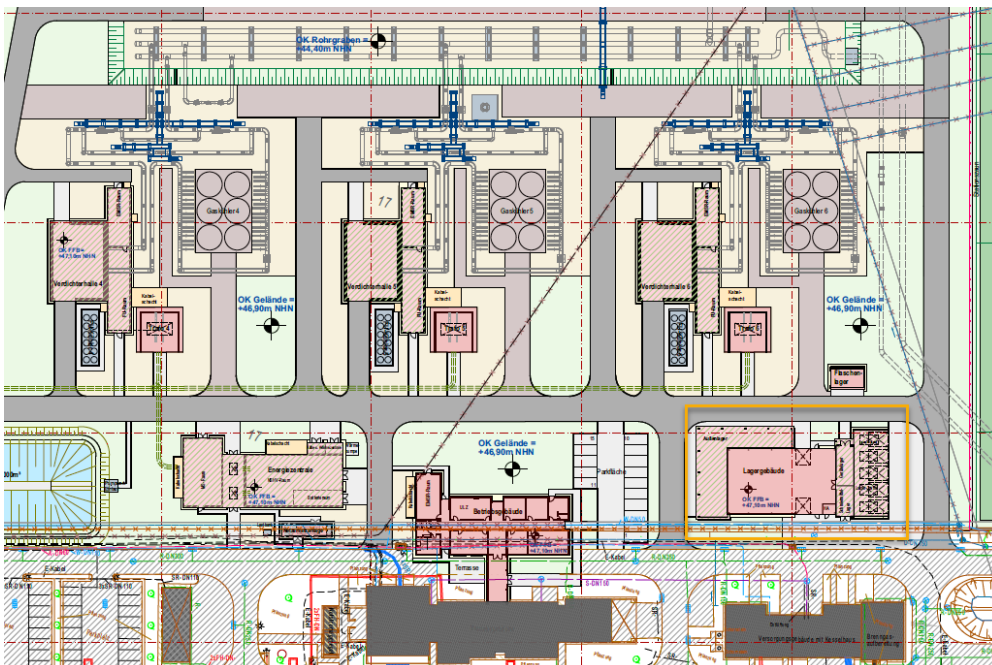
Ausschnitt aus dem Freiflächenplan – Lagergebäude (gelb umrandet)
